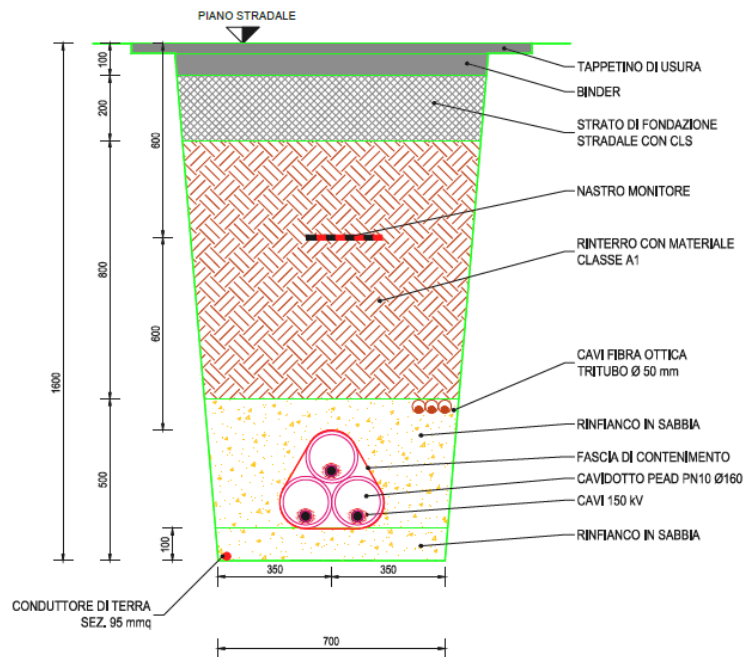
Sezione tipo cavidotto AT su strada asfaltata
